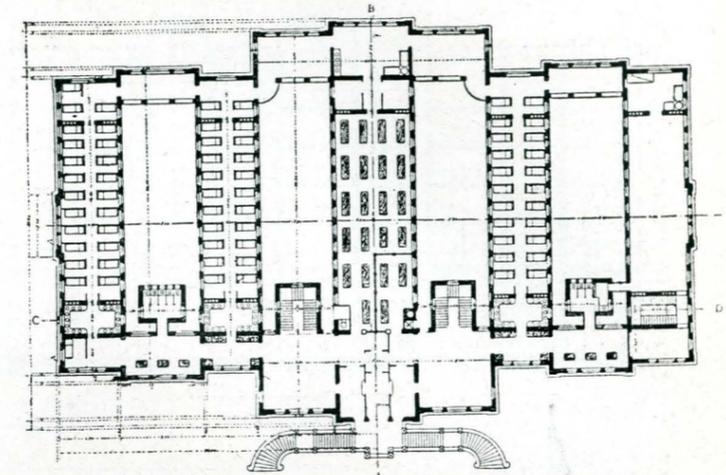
Pianta piano terzo - Albergo popolare e ristorante.
